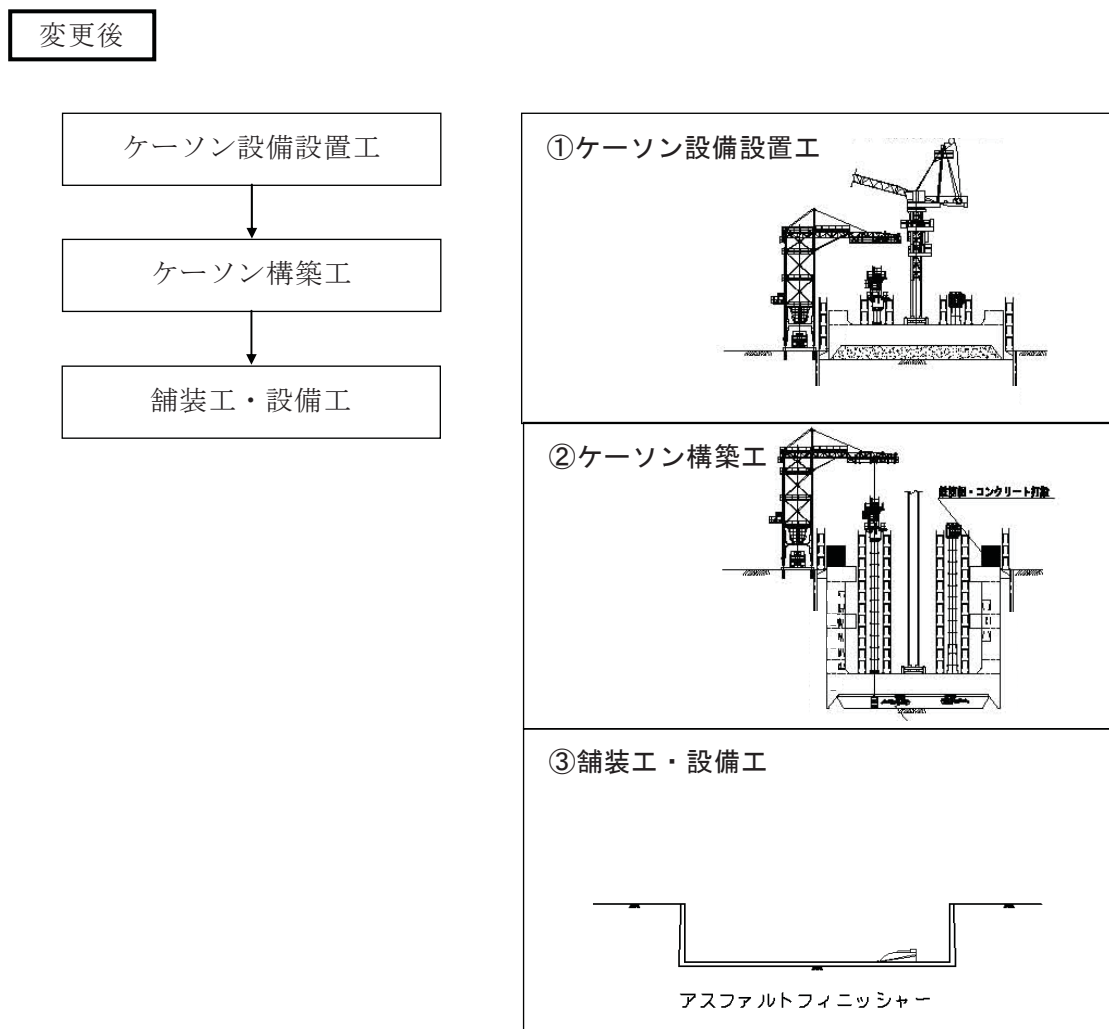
土工工事（一部区間）の施工順序（変更後）
